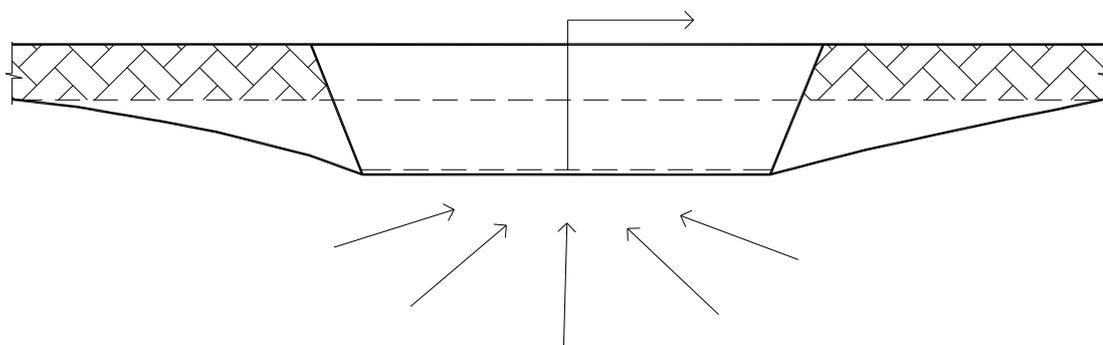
Открытый водоотлив с откачкой воды насосами в не оплывающих устойчивых грунтах
